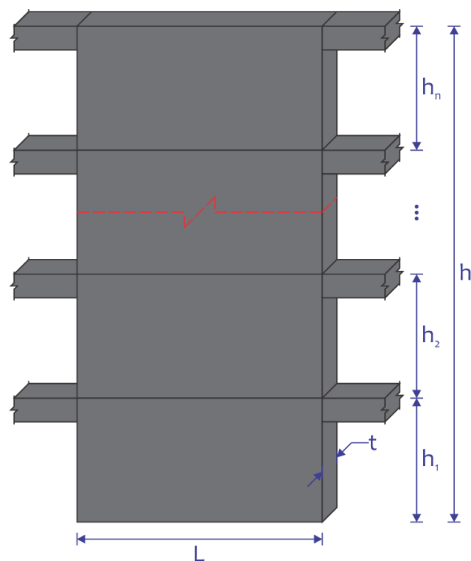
Variables Empleadas en la Placa de Concreto Armado.
